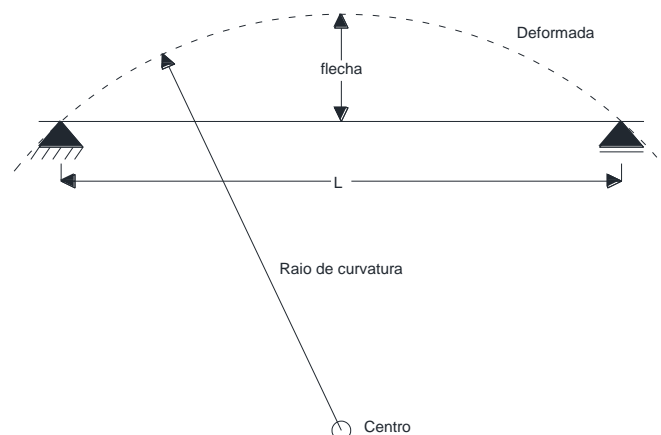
Raio de curvatura, flecha e deformada duma viga simplesmente apoiada sujeita à flexão
